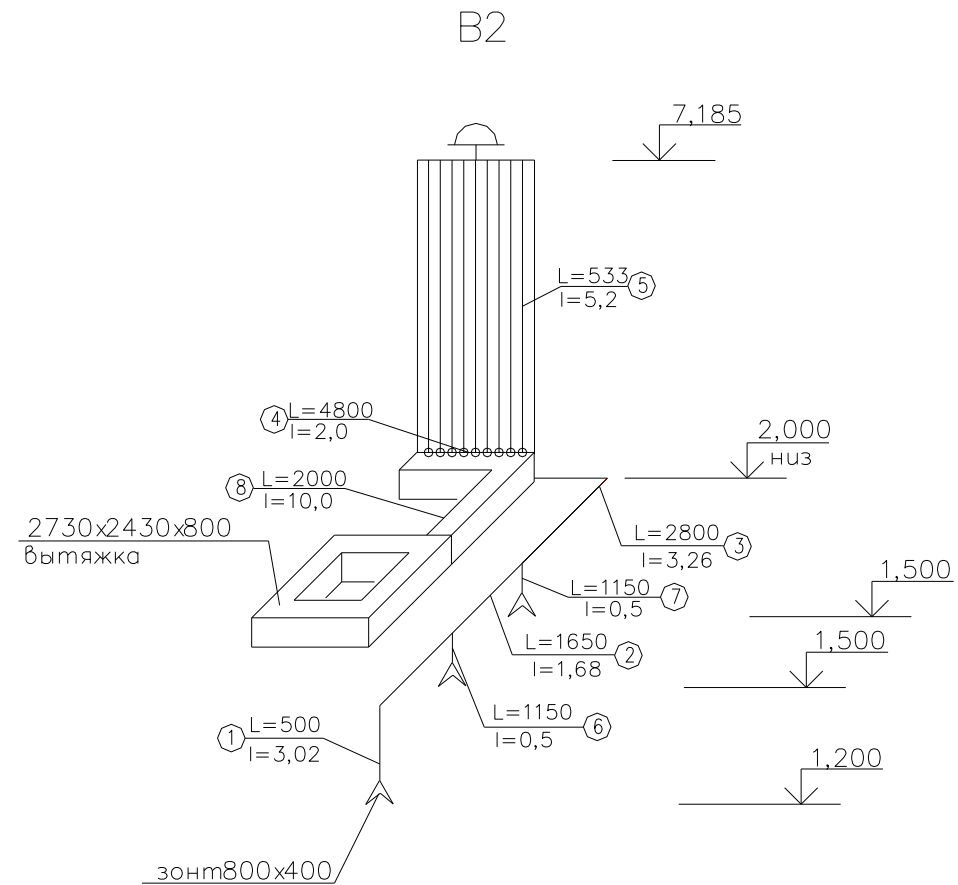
Расчетная схема механической вытяжной системы вентиляции B2
